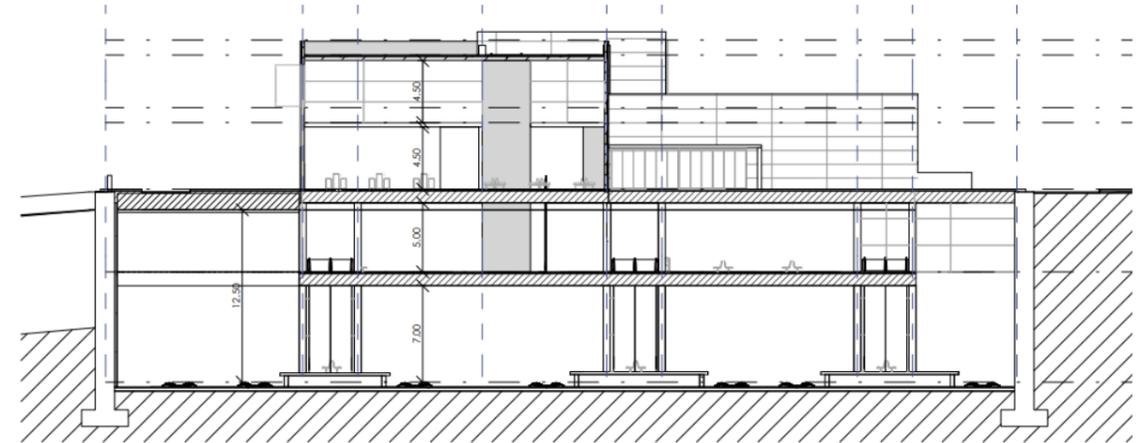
Sección transversal por el vial posterior, apreciando el nivel del terreno actual.
